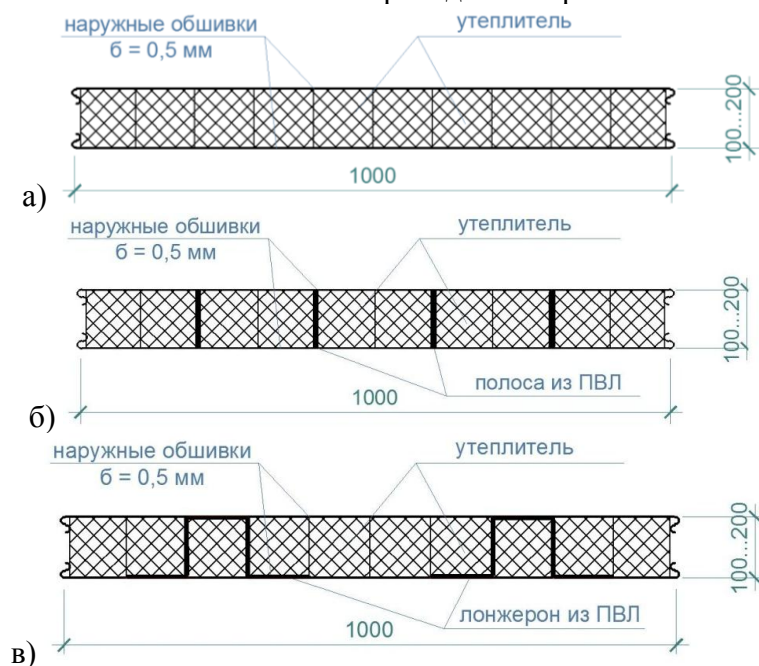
Поперечное сечение рассматриваемых сэндвич-панелей: а) традиционной; б) с армирующей полосой из ПВХ; в) с армирующим лонжероном из ПВХ.
